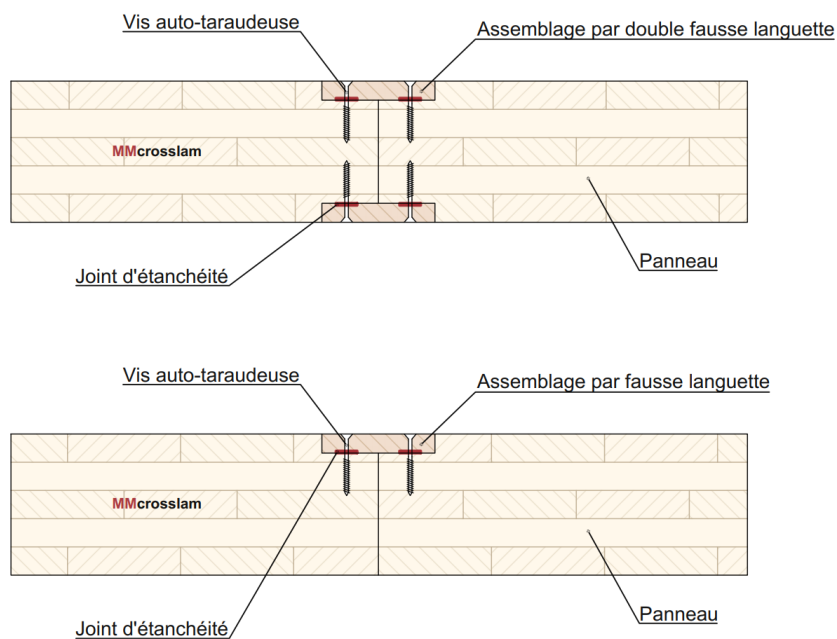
Jonction des panneaux MM crosslam entre eux – Mur (coupe horizontale)
